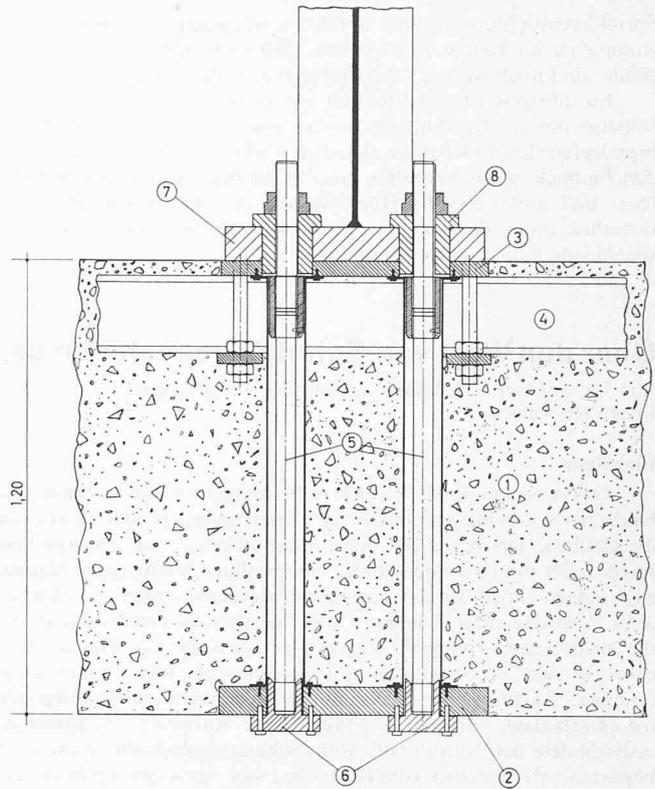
Schnitt 1:20 durch eine Verankerung. 1 Grundplatte, 2 untere Ankerplatte, 3 obere Platte, 4 I-Träger, 5 Bolzen vorgespannt, 6 untere Abschlusskörper, 7 Fussplatte von Aufbauteilen, 8 Schubhülsen
